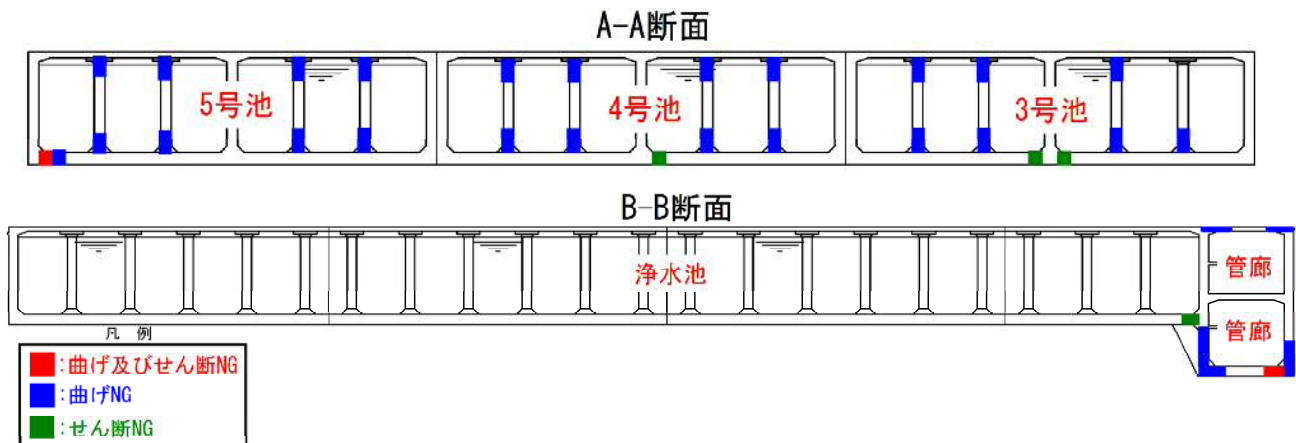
耐力不足箇所位置図 (横断面 (A-A 断面) 及び縦断面 (B-B 断面))
